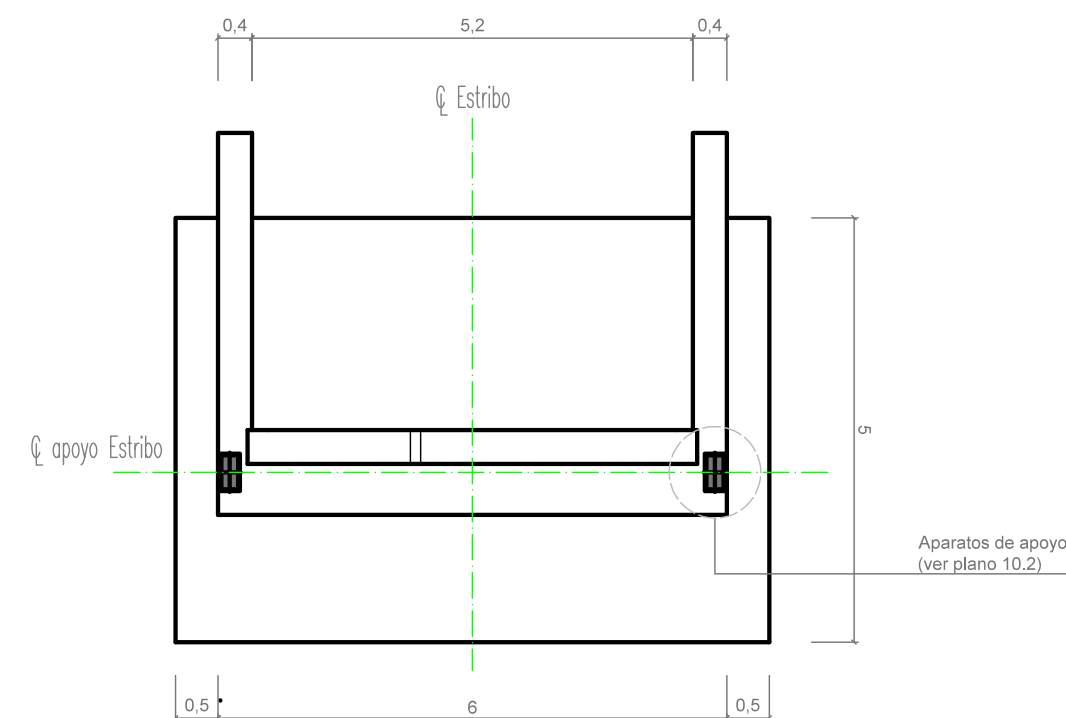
a. Planta de la cimentación (Escala 1:50).
